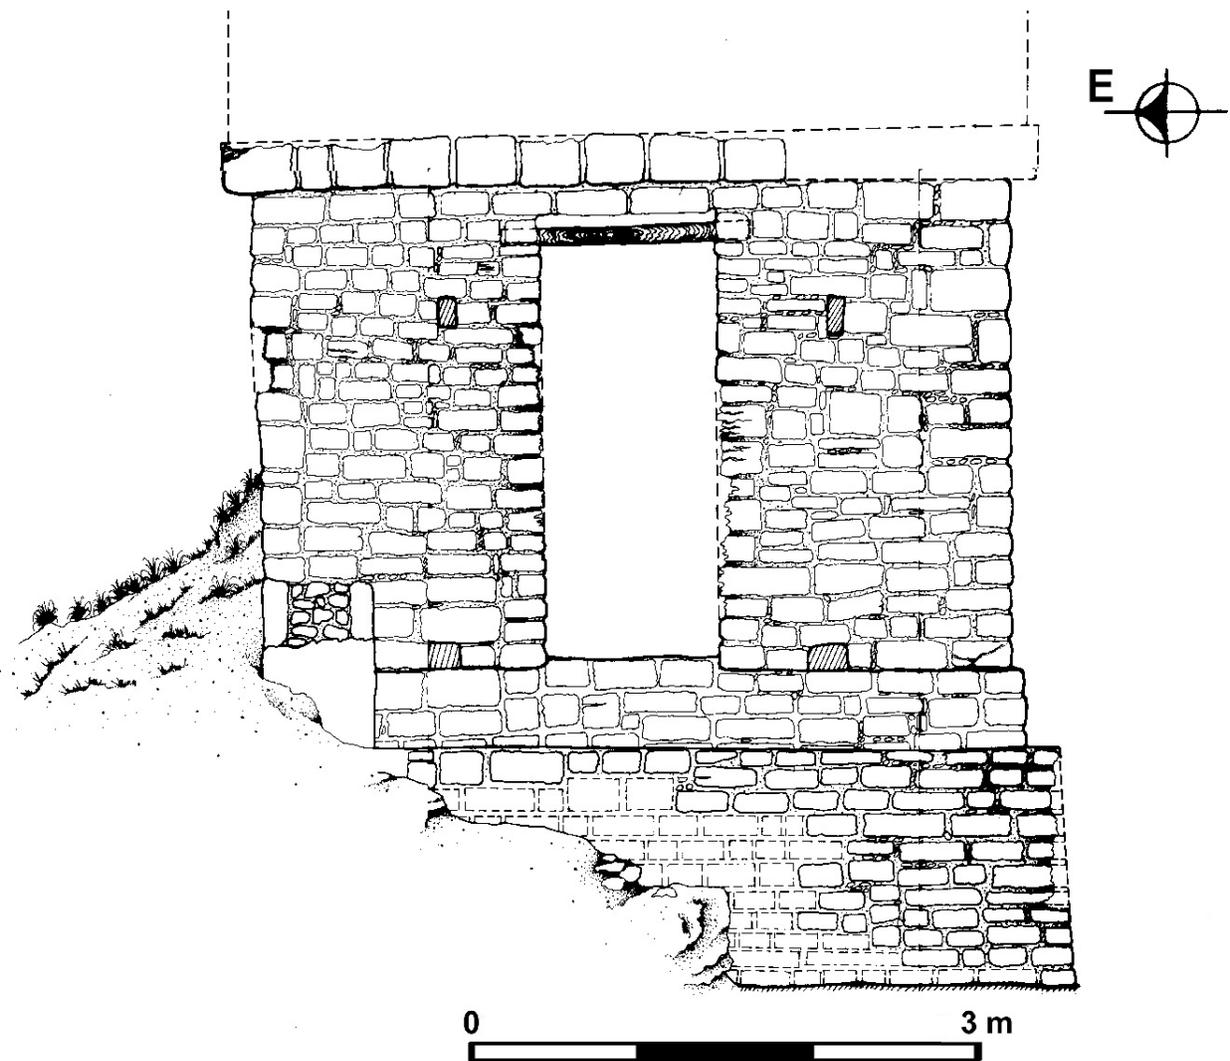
Fachada Norte, Estructura 5D-61, Acrópolis Central
